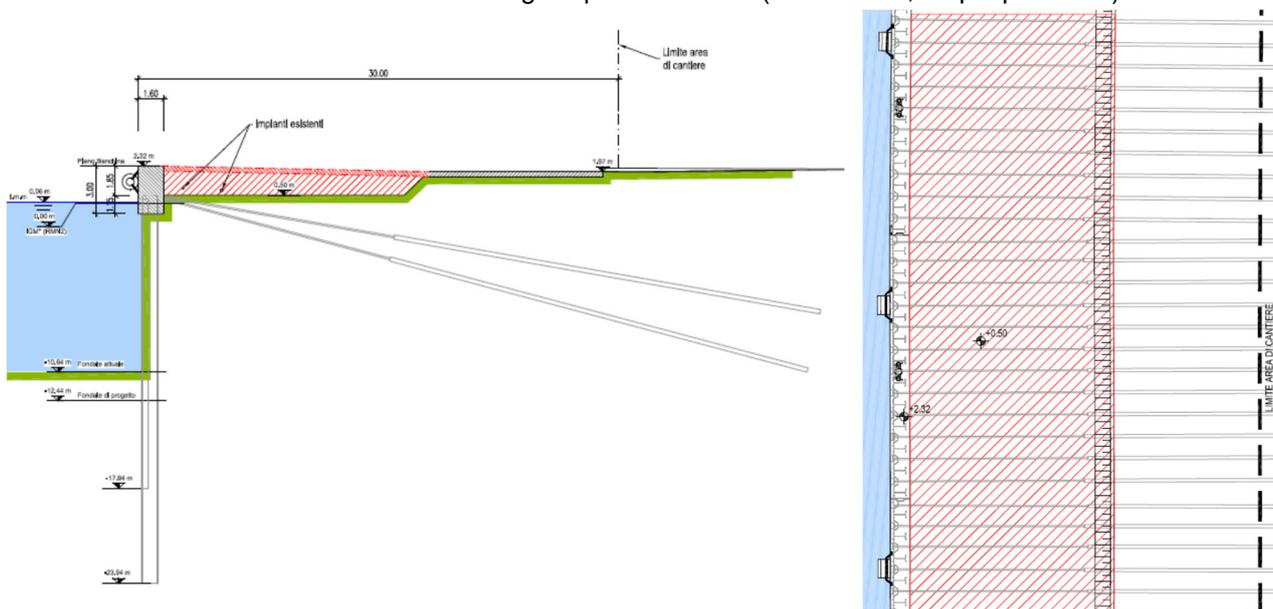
Banchina Trattaroli Nord – Fase 1 – Sezione e planimetria
